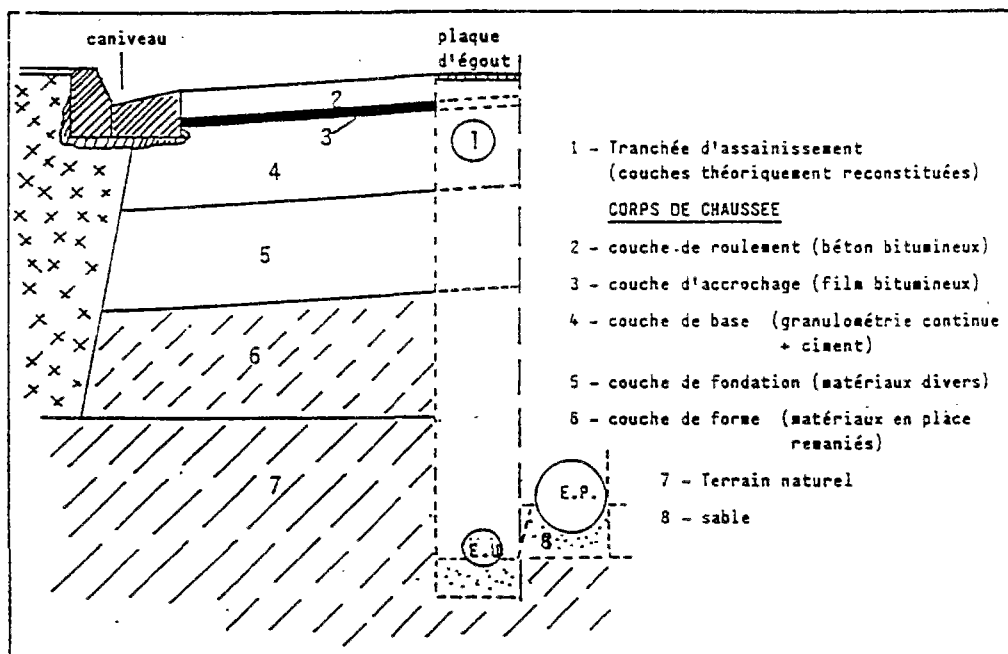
Profil en travers type des chaussées sur le site de Rezé
